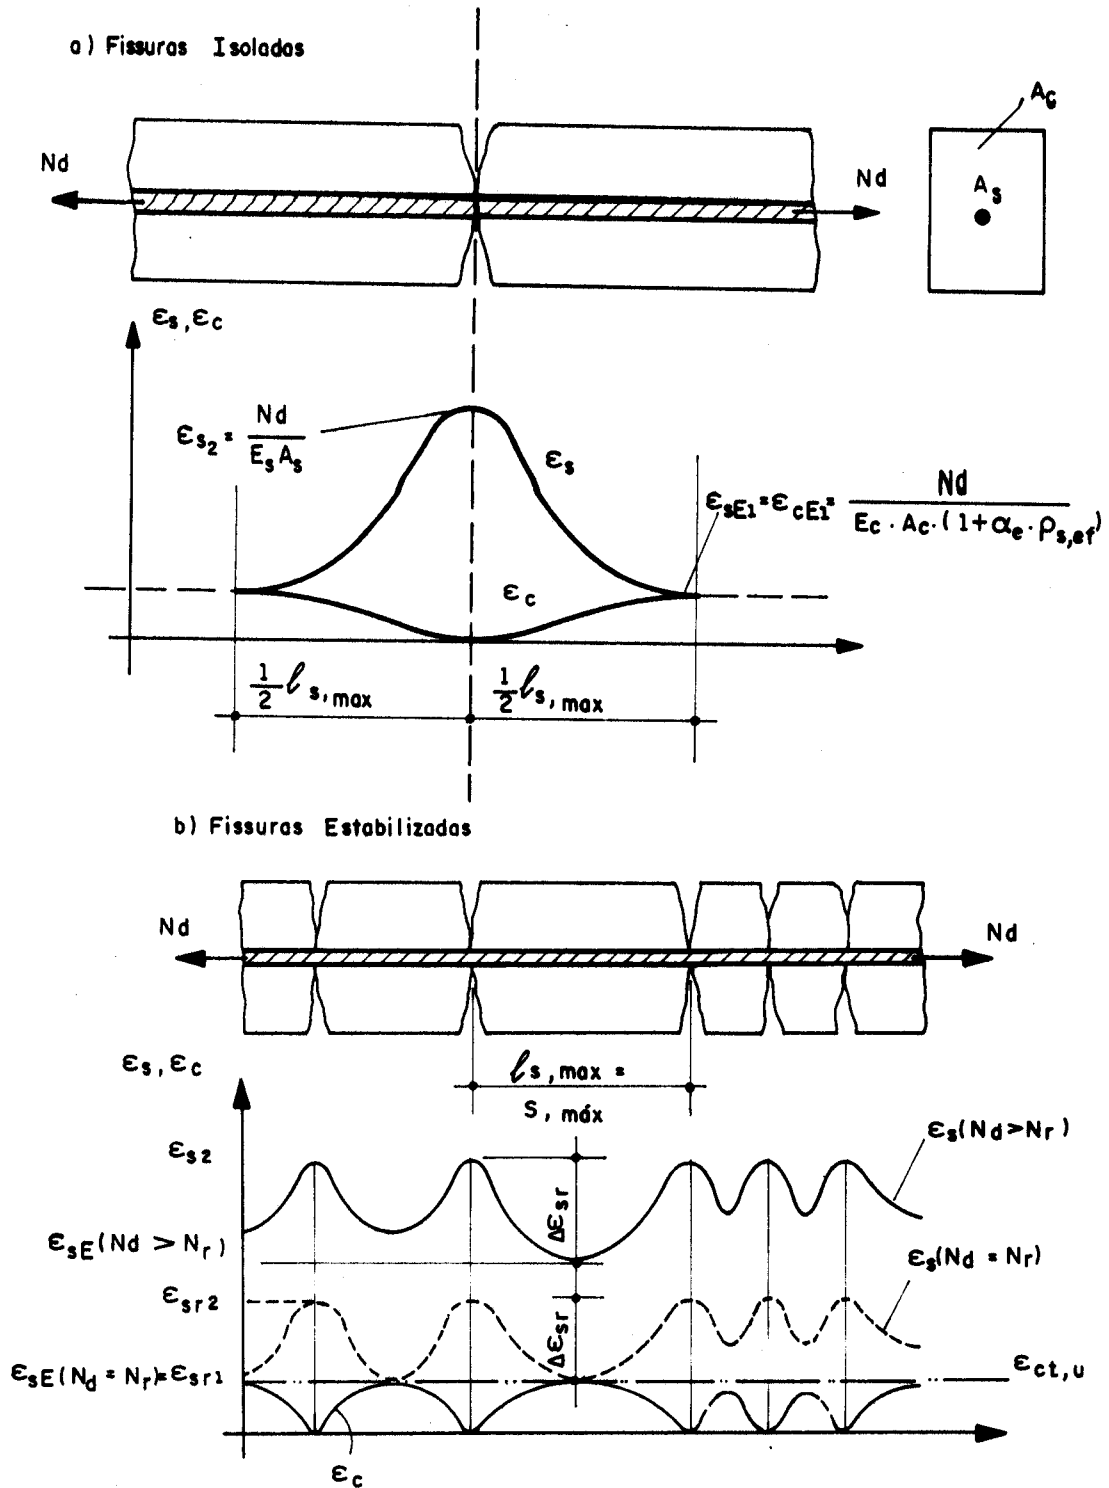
DEFORMAÇÕES PARA O CÁLCULO DO ESPAÇAMENTO DAS FISSURAS E DEFORMAÇÕES MÉDIAS - CEB⁵
